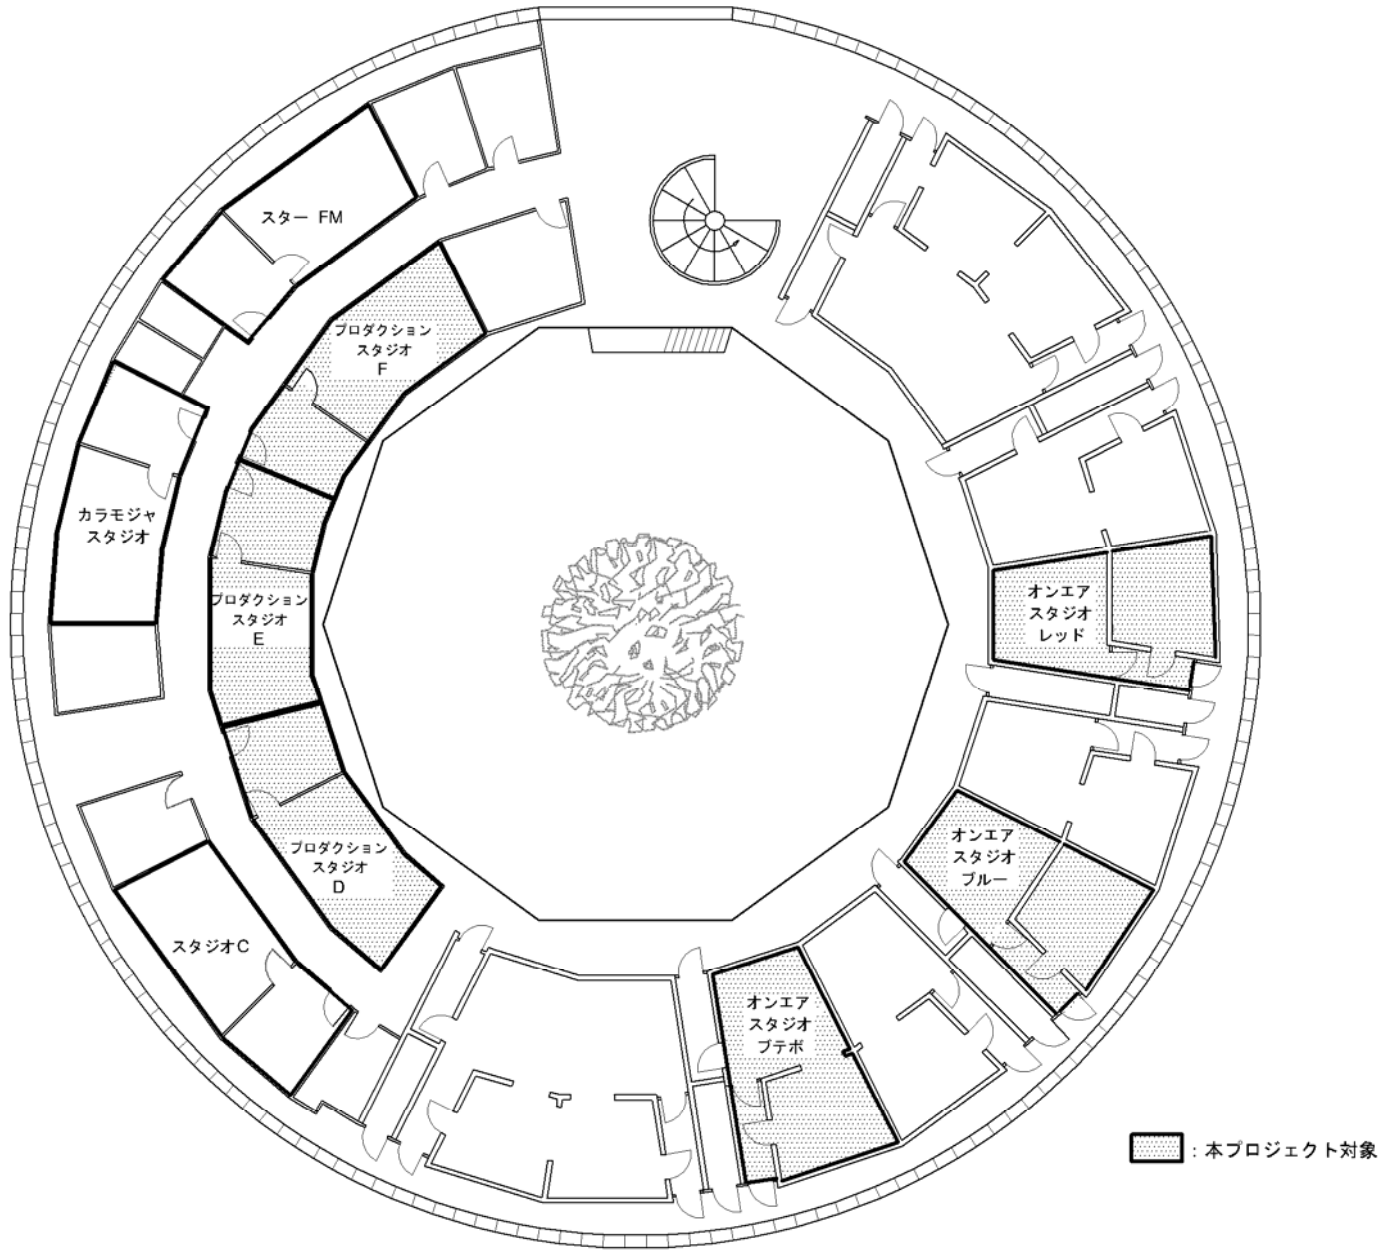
カンパラ放送局スタジオ棟1F 平面図 1/300
